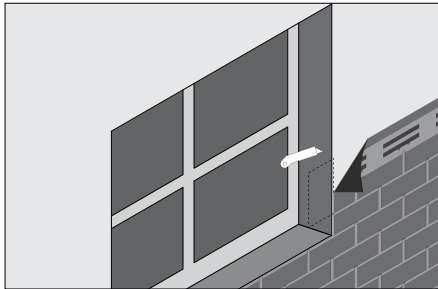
Монтаж фасадной плитки вокруг оконных проемов
